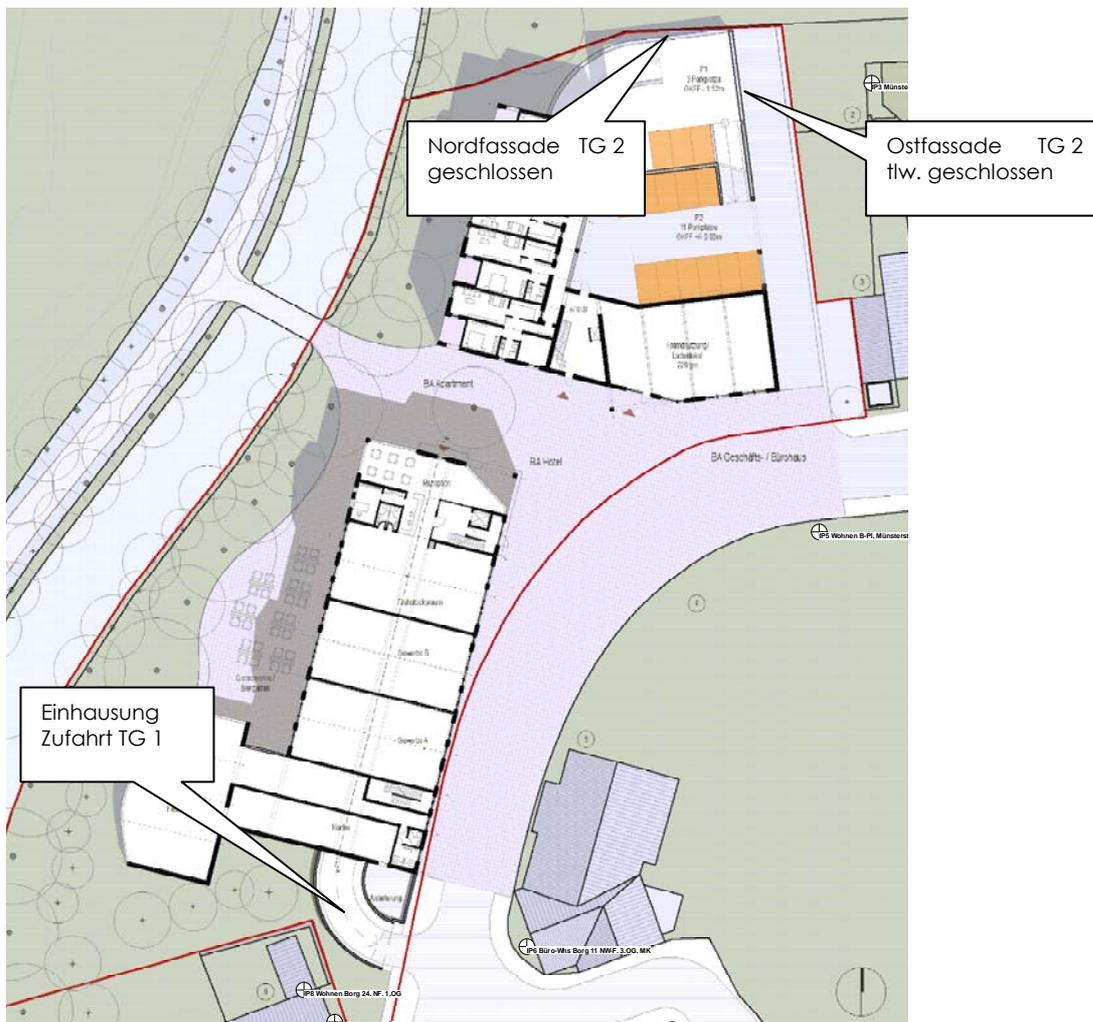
Lageplan mit Darstellung der erforderlichen Einhausung
